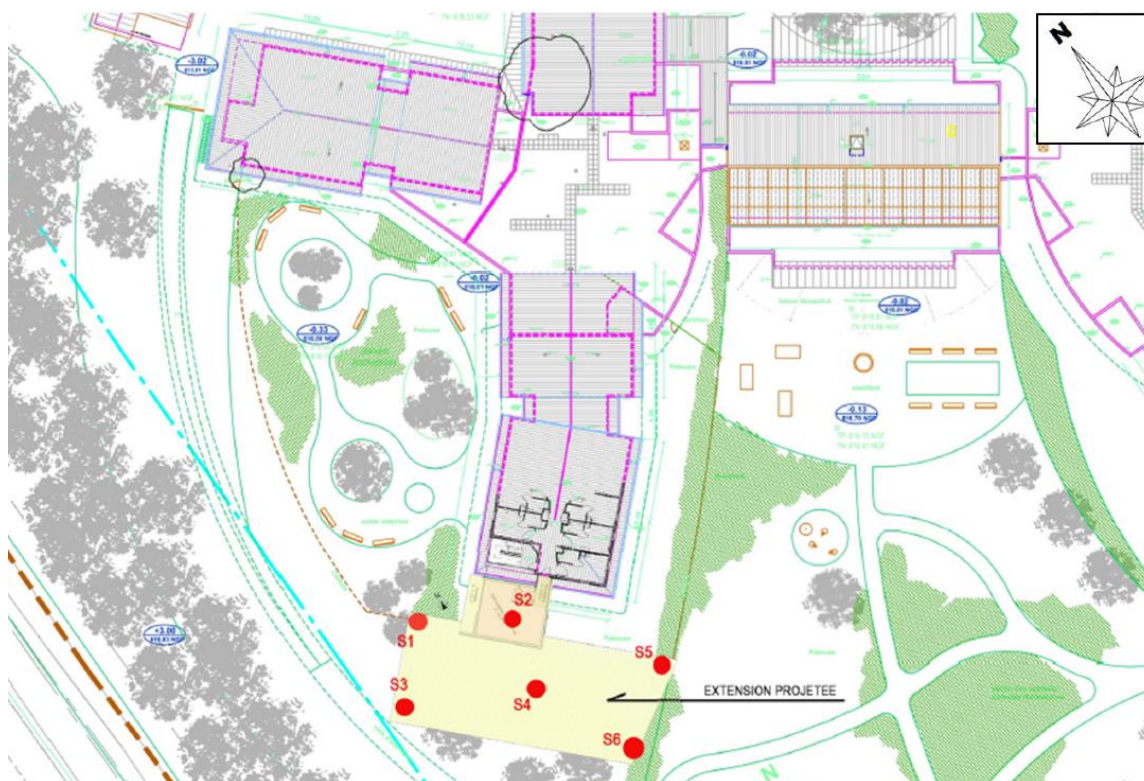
Extrait du plan de masse du bâtiment et du projet – CETEL
